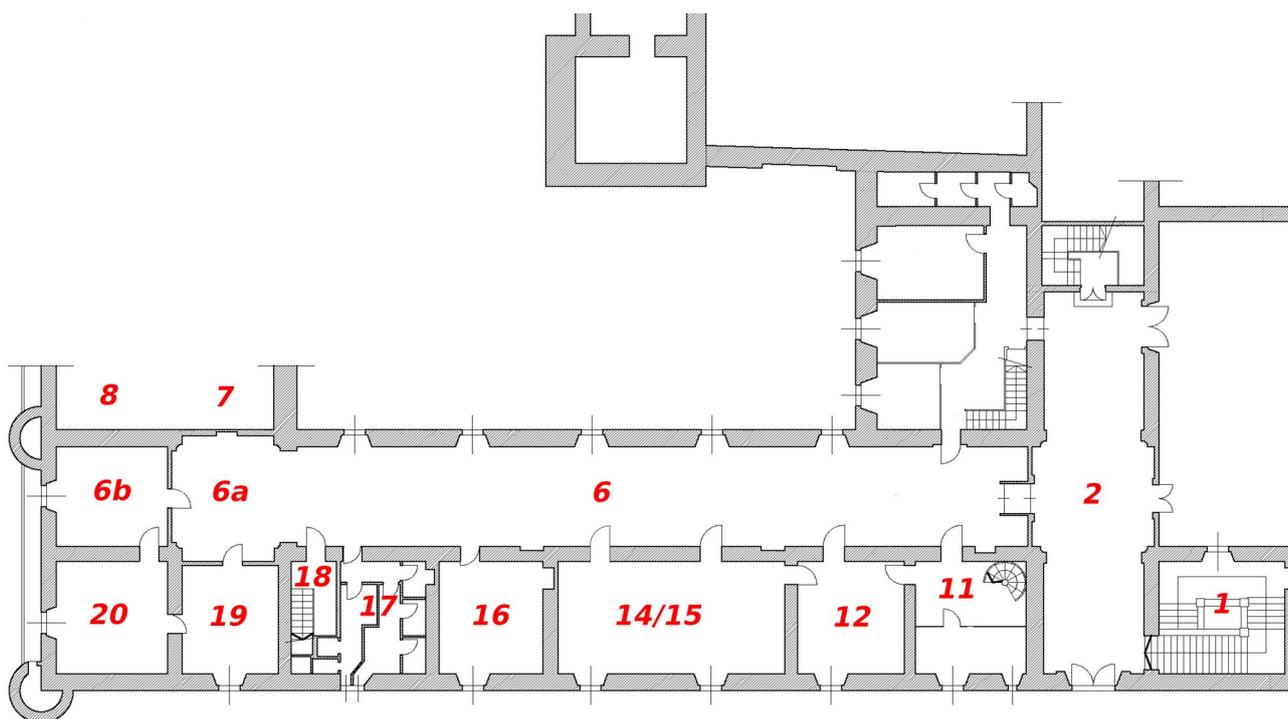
Planimetria della disposizione attuale degli spazi al secondo piano dell'Osservatorio; le stanze sono state contrassegnate con la stessa numerazione usata nella figura 13. La pianta è orientata con il sud a sinistra.
